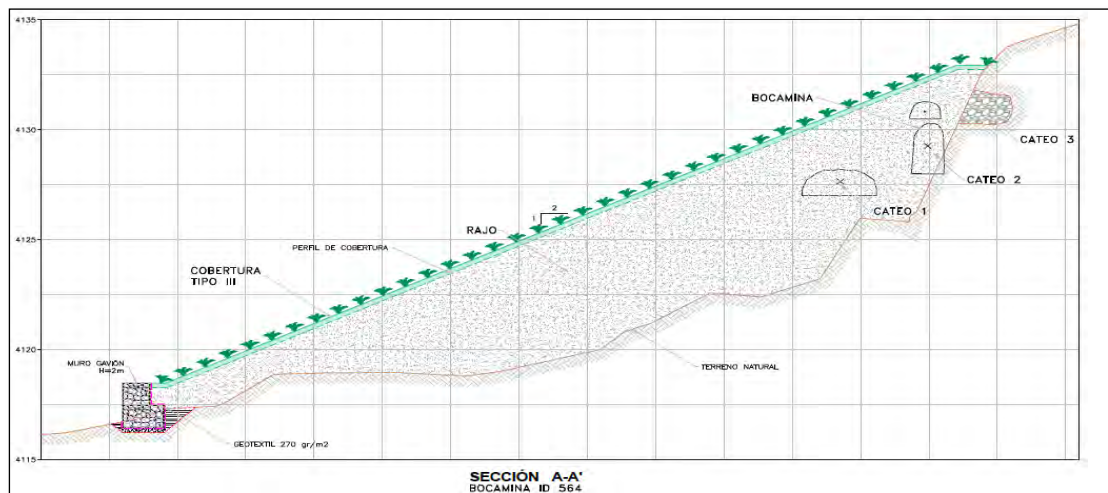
Perfil Longitudinal del Cierre componente ID 564
